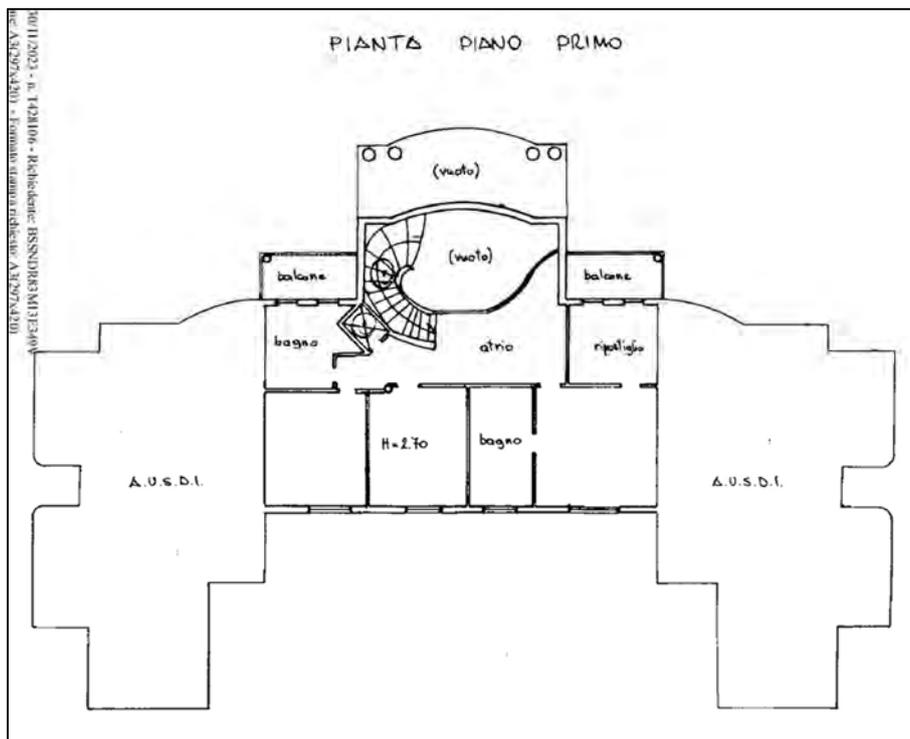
planimetria catastale del piano primo dell'abitazione identificata con la particella 169 sub 1
